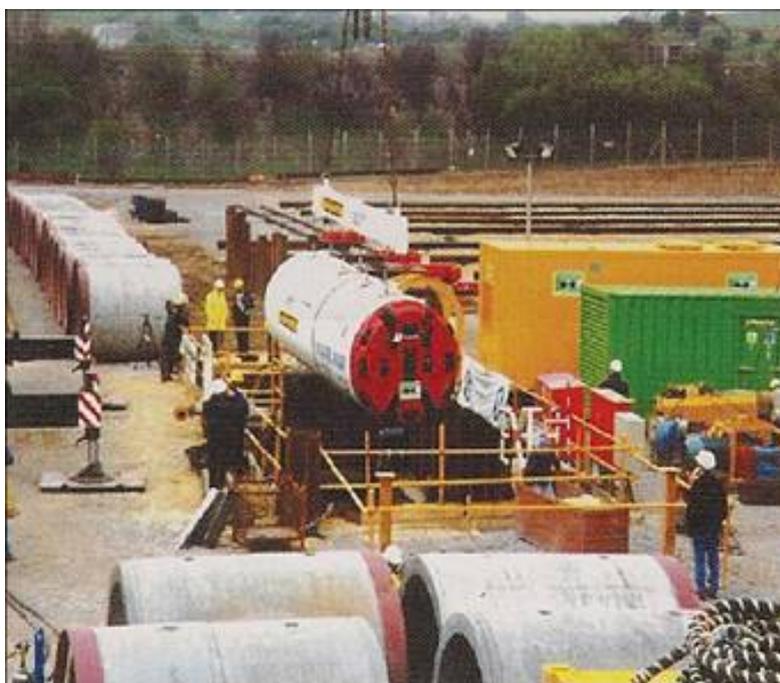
Outro exemplo de Shield para Pipe Jacking (em rocha), com os tubos de revestimento a serem cravados, pré fabricados, em 1º plano.
